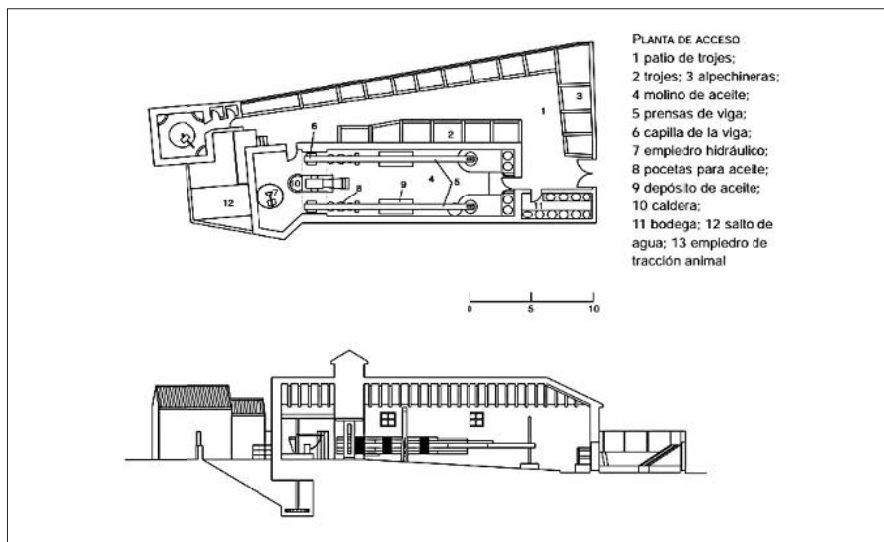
Planta y alzado de la almazara de las Laerillas de Cortijos, Haciendas y Lagares provincia de Granada. © Junta de Andalucía
